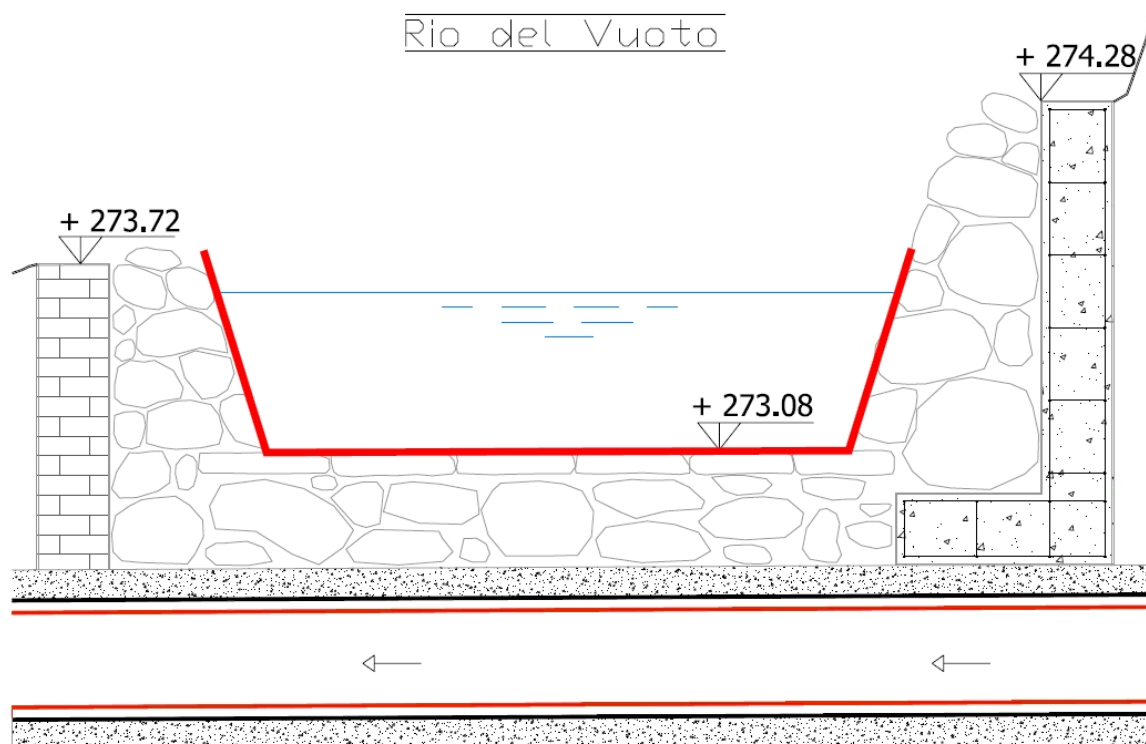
Sezione di attraversamento del Rio del Vuoto in progetto
